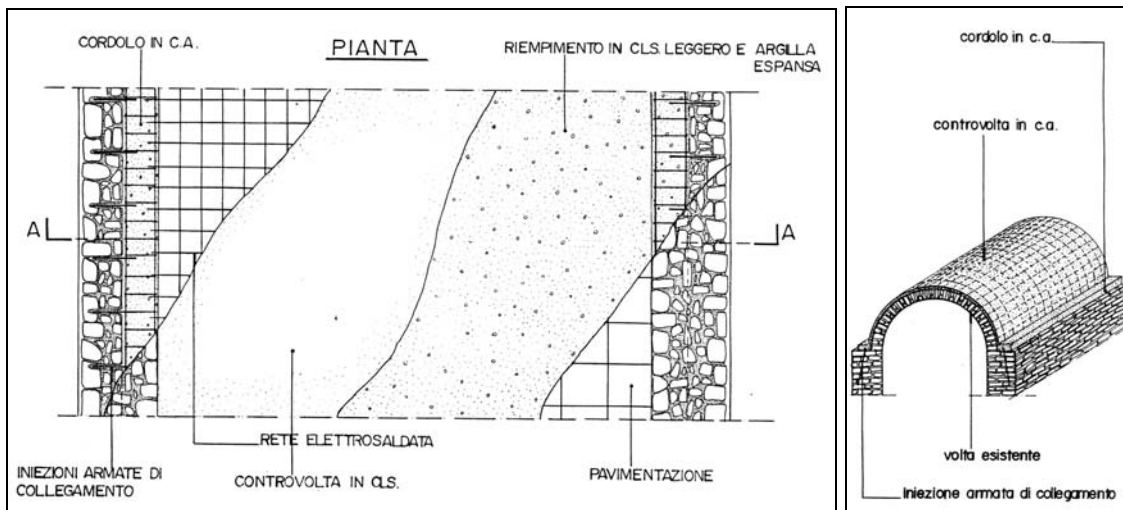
/a. Consolidamento con cappa in cemento armato. Pianta e schema assonometrico (Rocchi, Piccirilli-1991)
